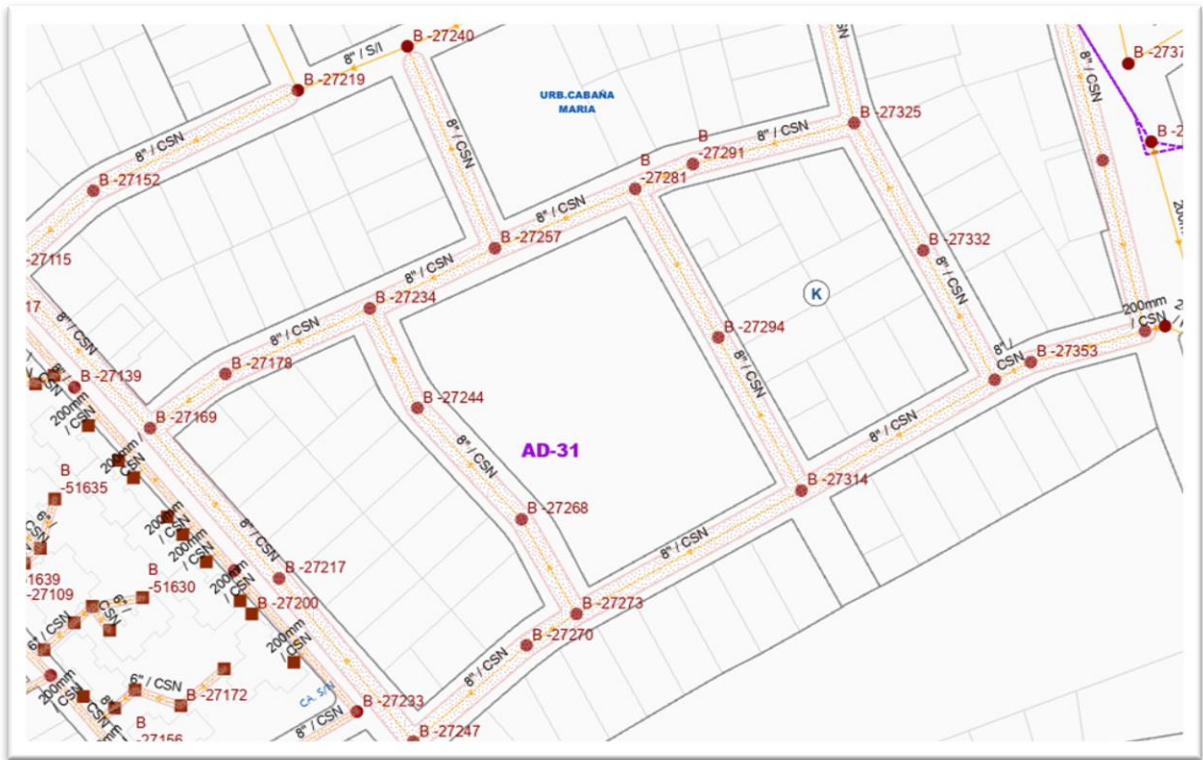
Estructura del sistema de alcantarillado Arequipa Metropolitana
